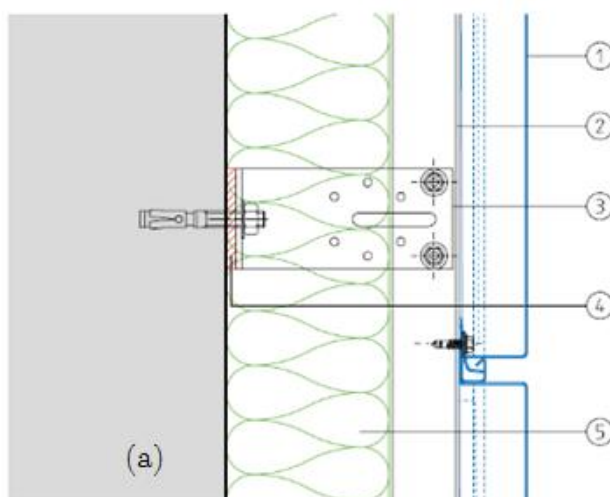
Sistema cassetes modulares com isolamento (a) - Estrutura de suporte, 1 – Painel modular, 2 – Perfil e calha, 3 – Cantoneira de fixação, 4 – Calço e 5 – Isolamento exterior.
